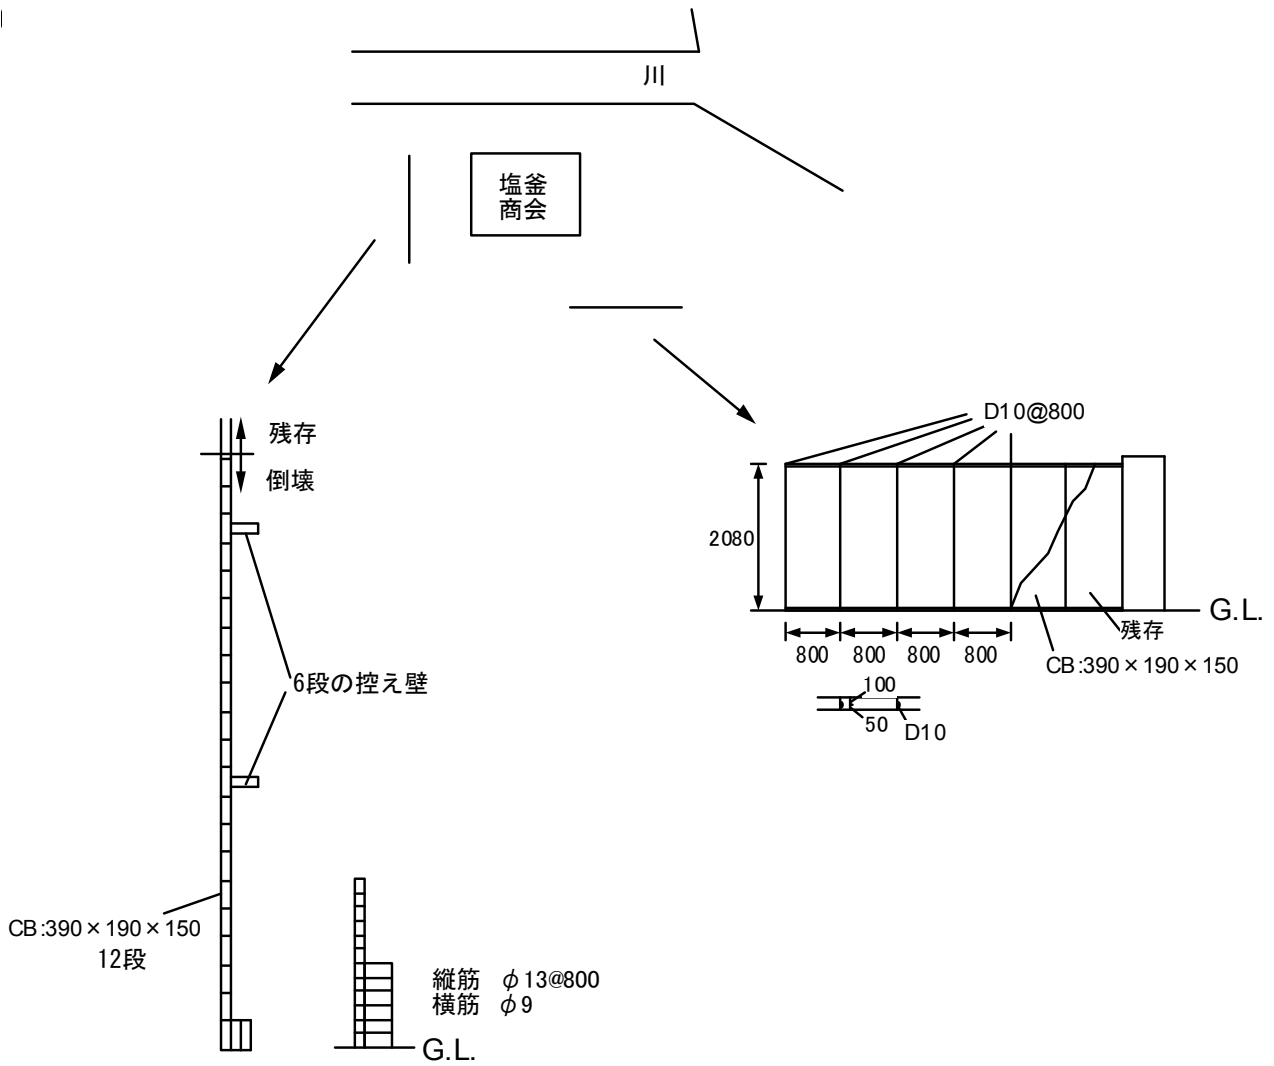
CB 塀の配置図・立面図および寸法
